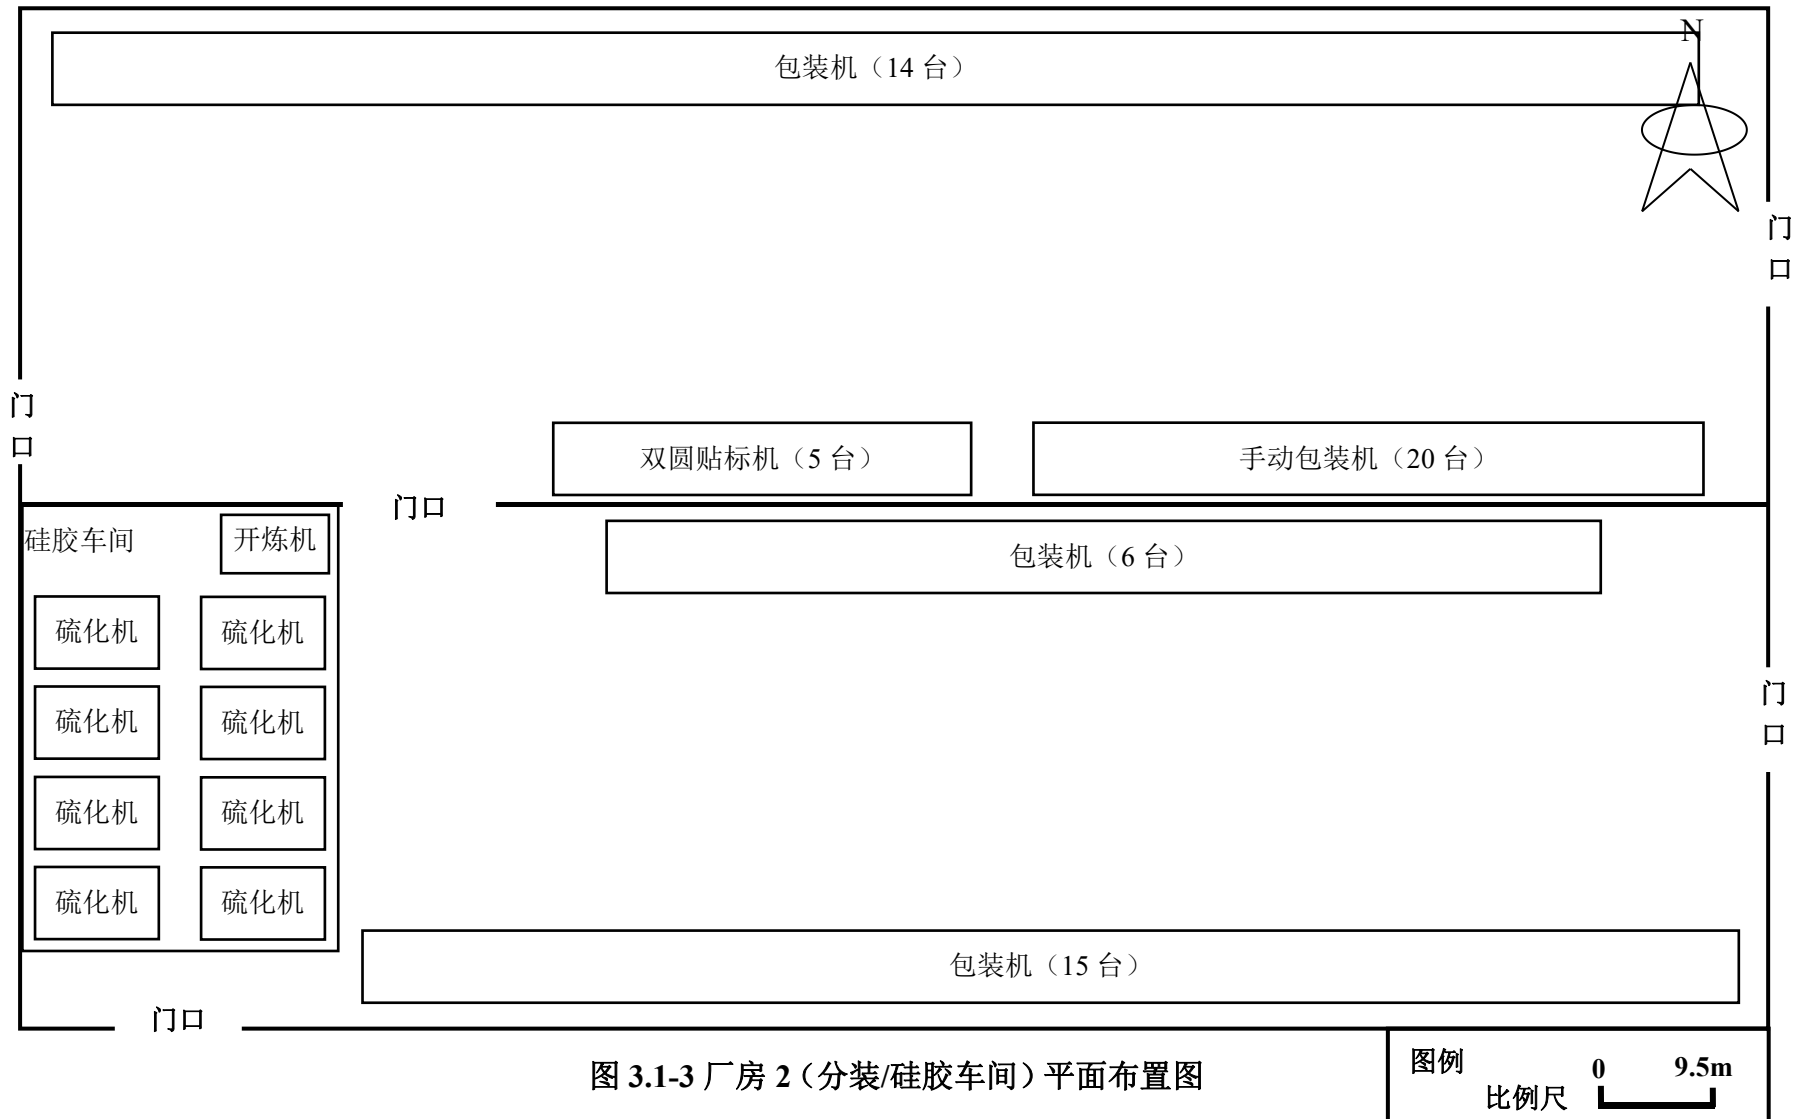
厂房 2 (分装/硅胶车间) 平面布置图
